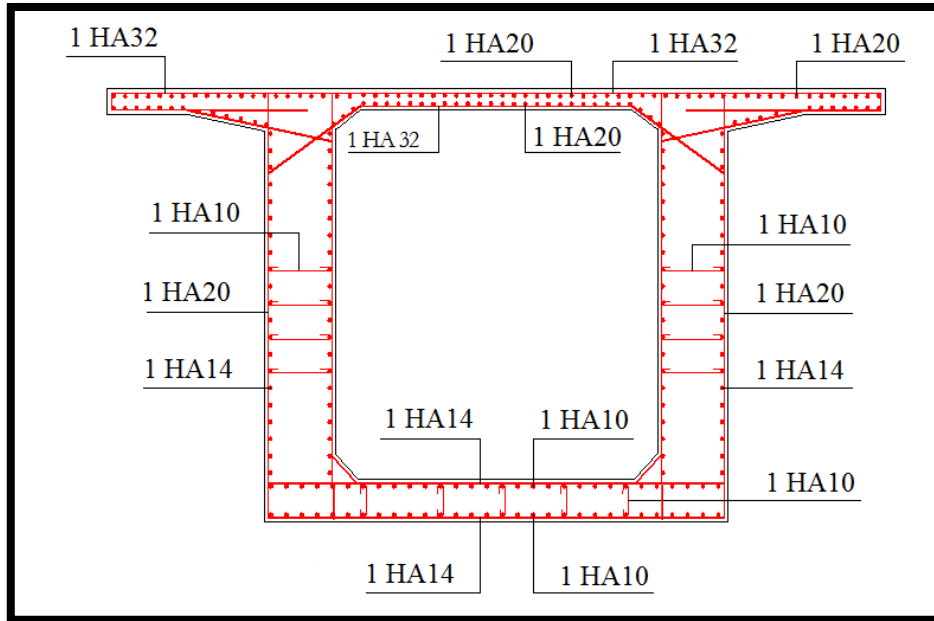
Ferrailage du voussoir près de la pile.
